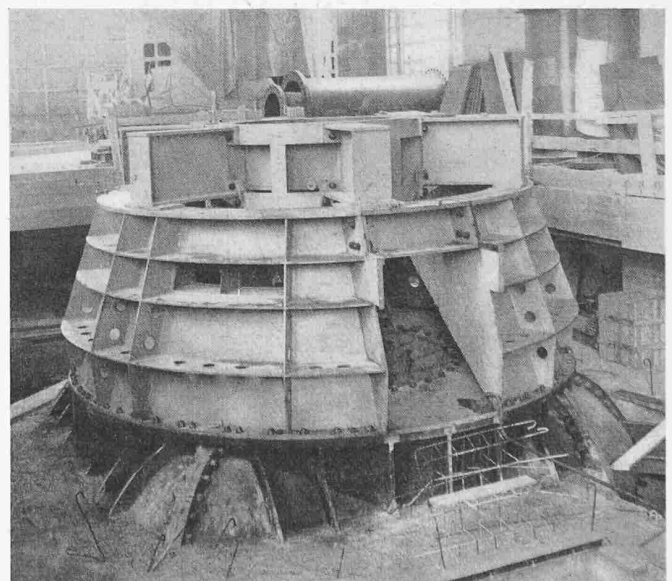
Stützring, darunter das teilweise einbetonierte Gehäuse
